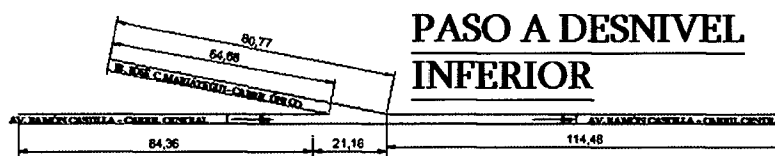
Planteamiento en Planta del paso a desnivel inferior.
